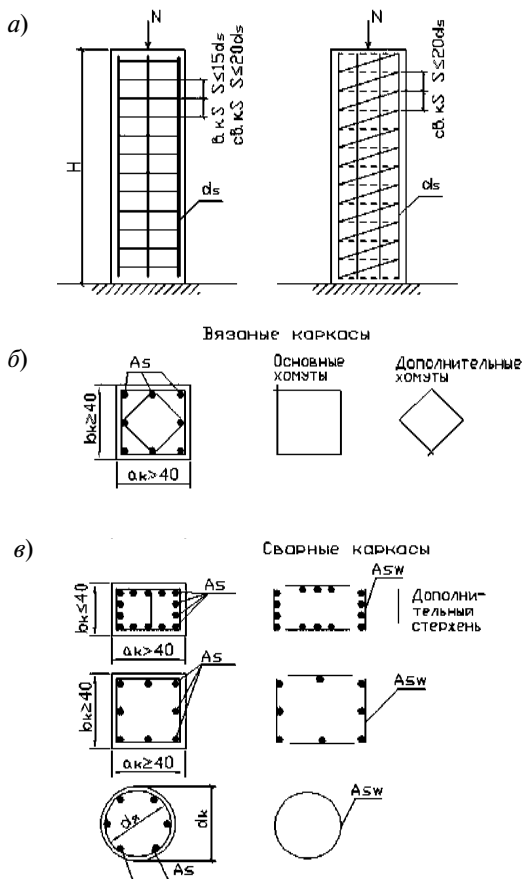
Схема армирования колонны, работающей на центральное сжатие (а); б — вязаными каркасами; в — сварными каркасами
